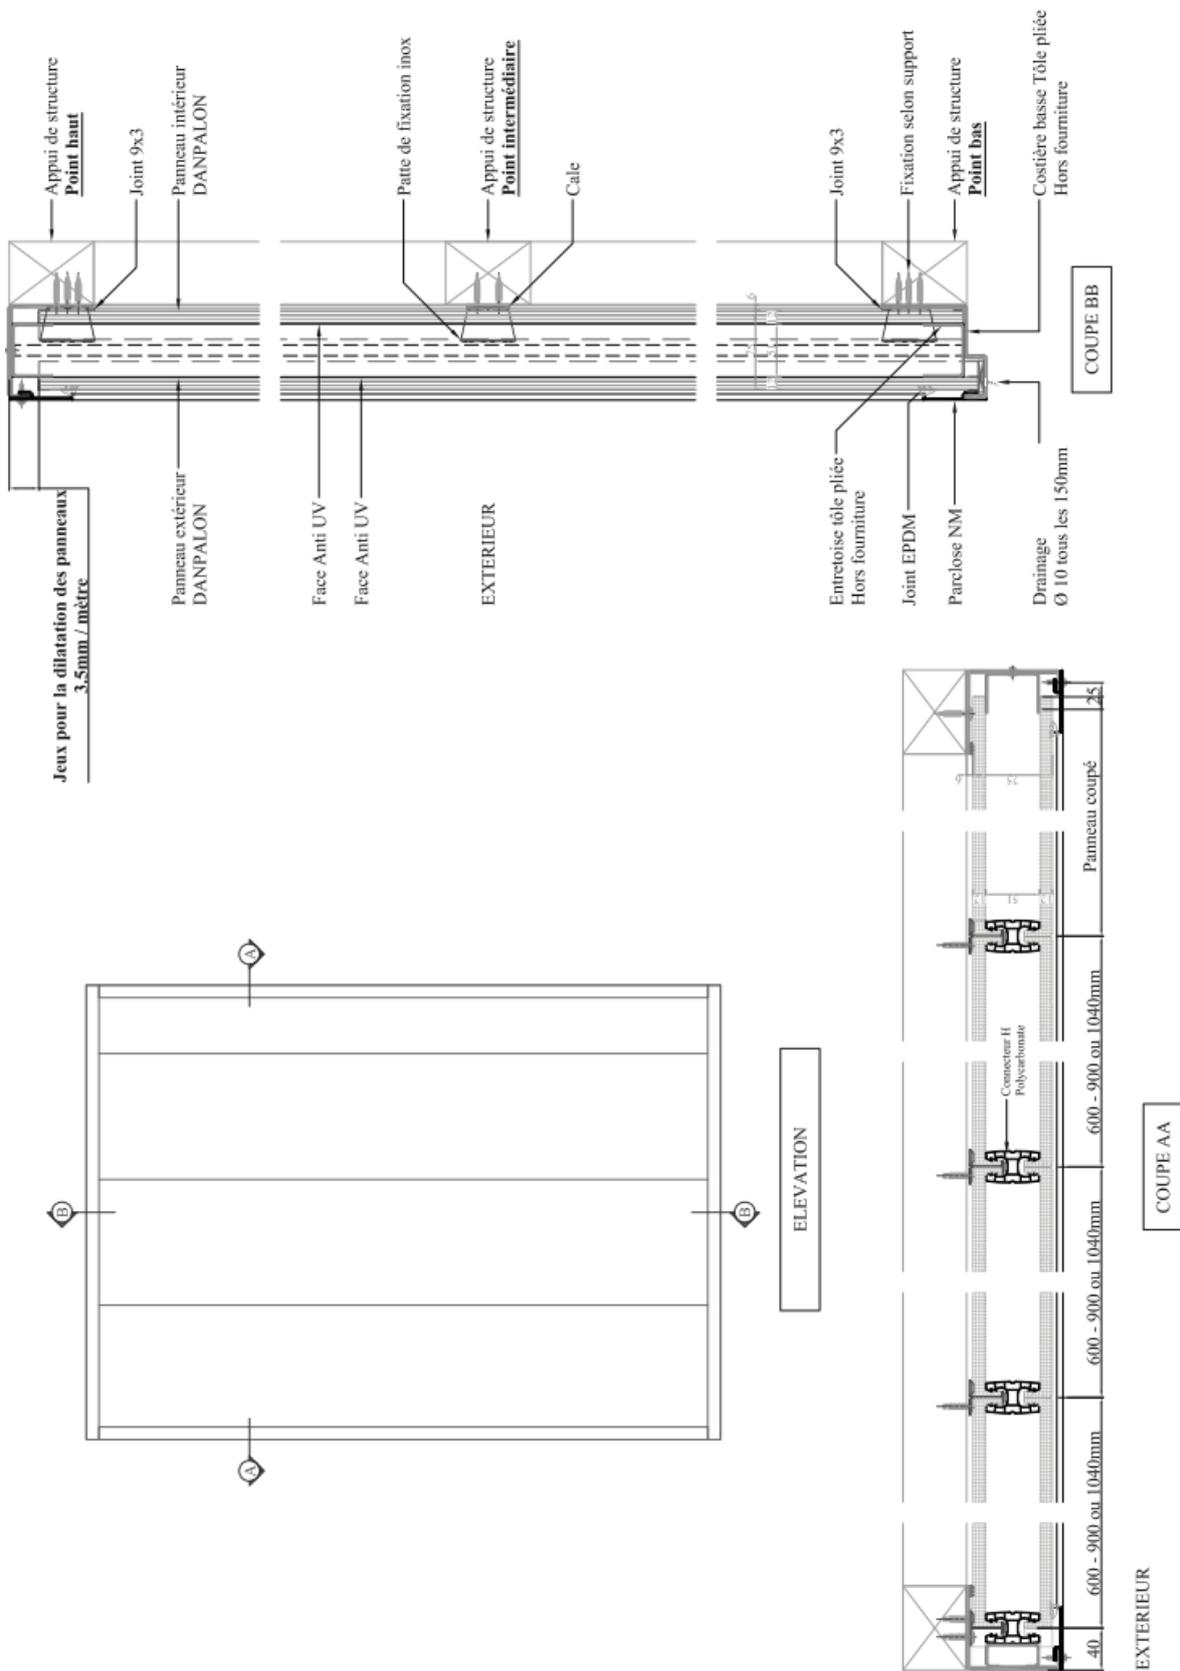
Coupe longitudinale et transversale sur connecteur H polycarbonate – Système DANPATHERM
